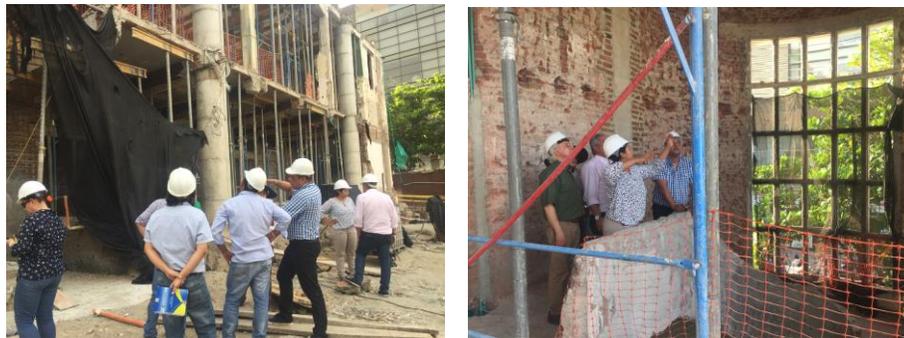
Reforzamiento Estructural Zona de Conservación y Restauración Arquitectónica
